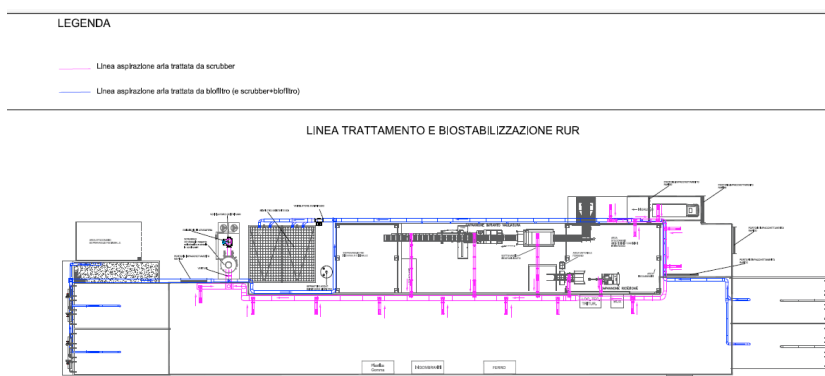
stralcio estratto da Tav.11 rev.01 "Planimetria progetto rete impiantistica trattamento arie"
